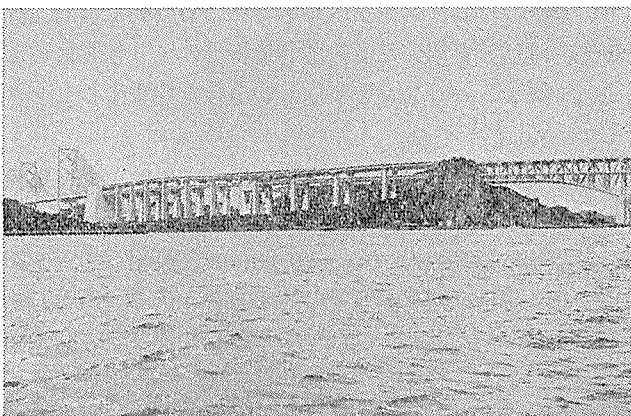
与島高架橋の概要 (写真上にプロットした予想図)
